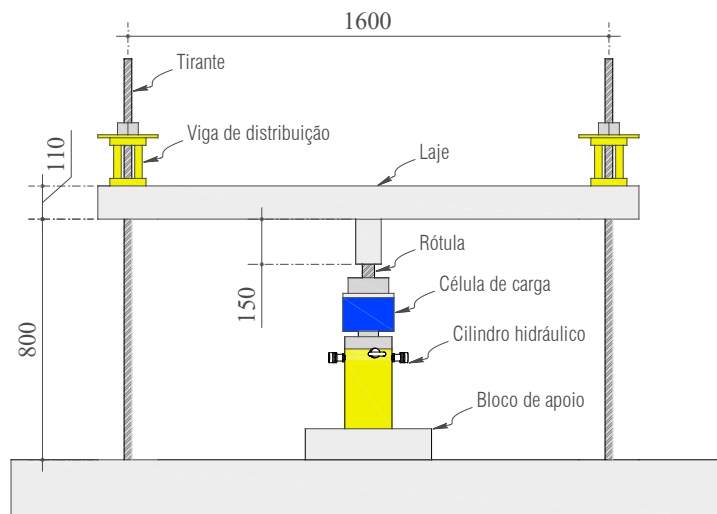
Detalhe frontal do sistema de ensaio (mm)
